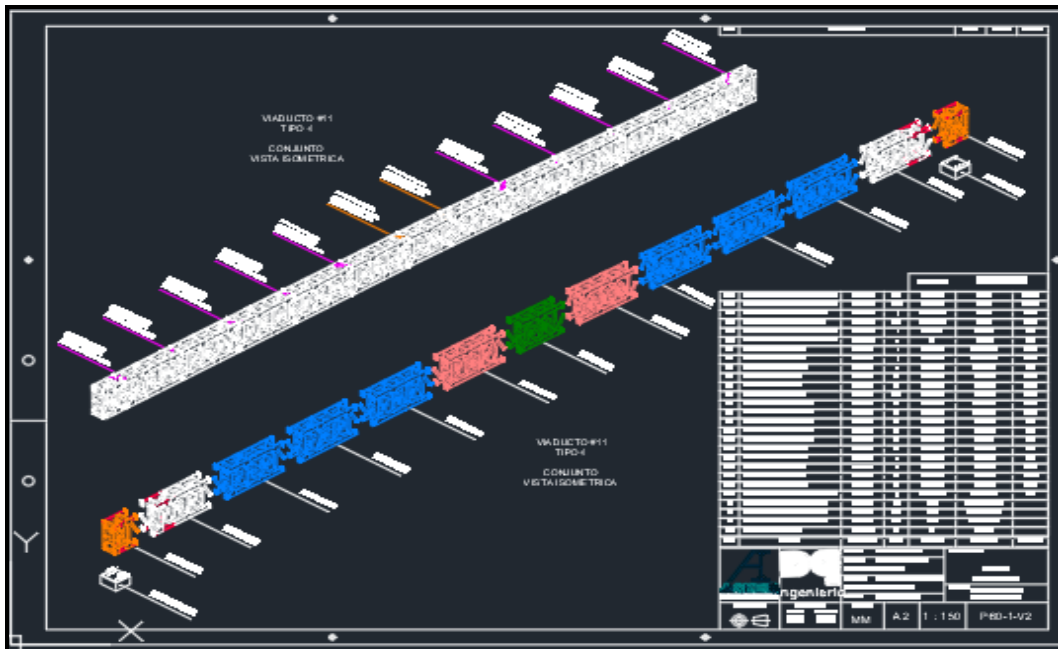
PLANO 3D DEL VIADUCTO GRANDE
